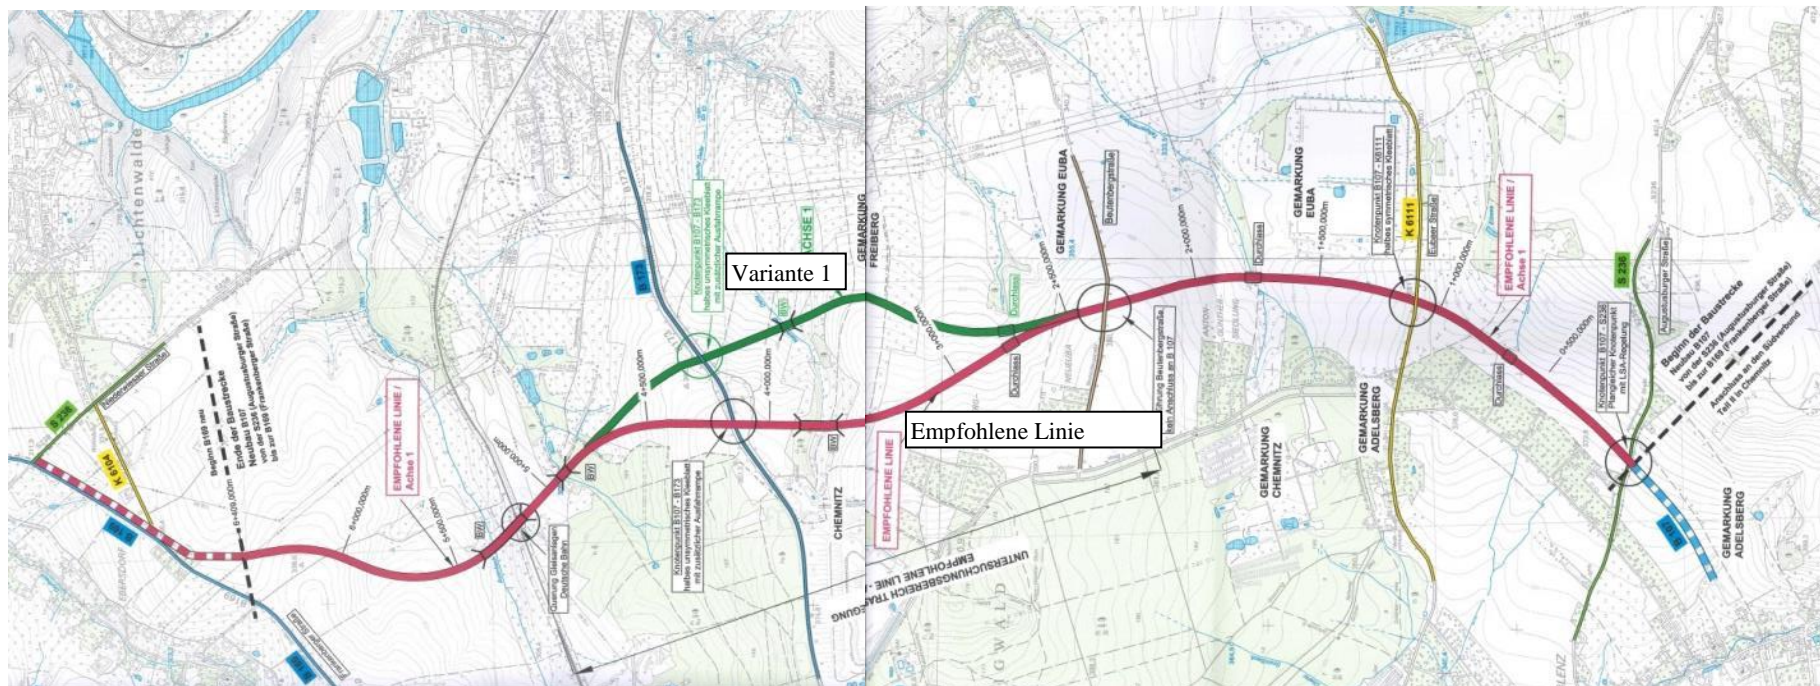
Lageplan der Variante 1 und der Empfohlenen Linie (grün: Variante 1; rot: Empfohlene Linie) (Unterlage 3.1 - Übersichtlageplan Linienfindung, Vorplanung September 2007)
